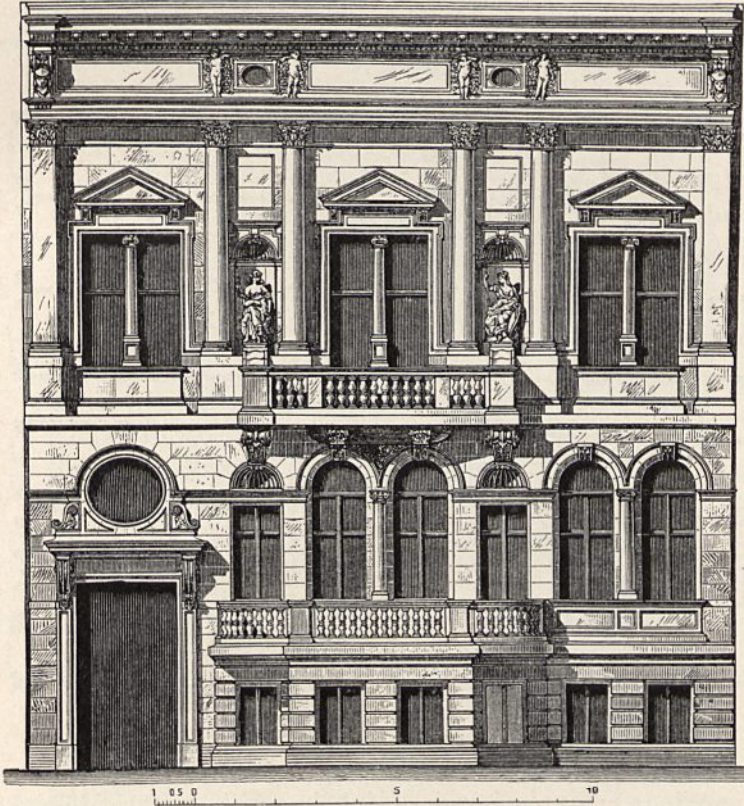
Wohnhaus Wallich in Berlin, Bellevuestraße 18a.
